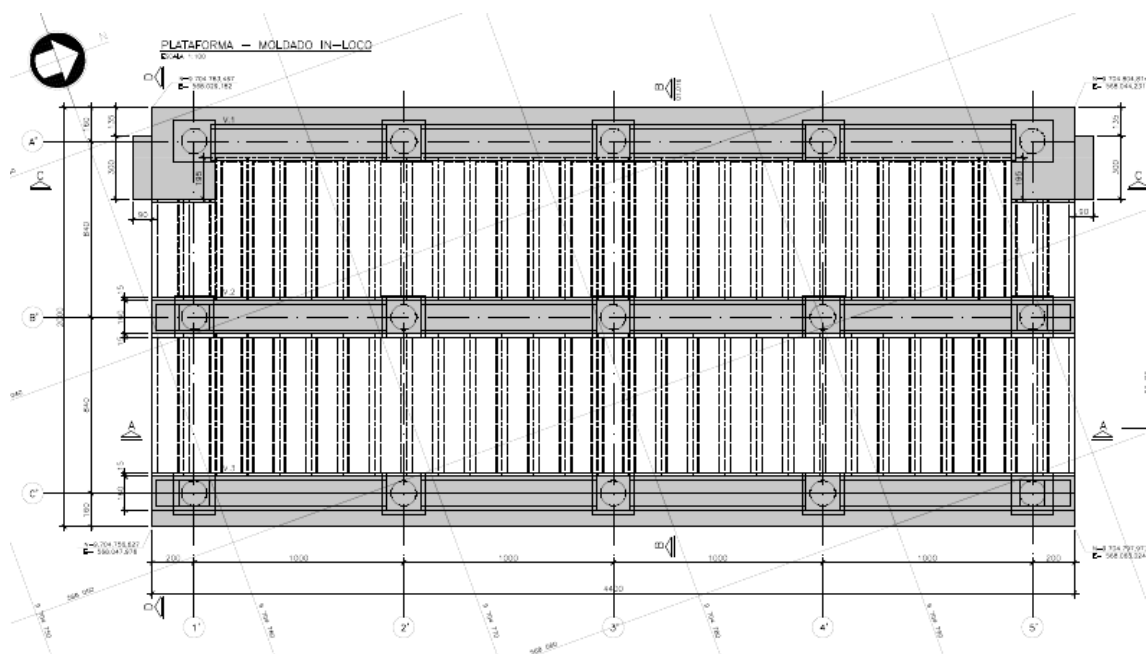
Planta da Plataforma do Terminal (Desenho LYO02A-S1D-01-015). Fonte: LC Terminais (2022).
